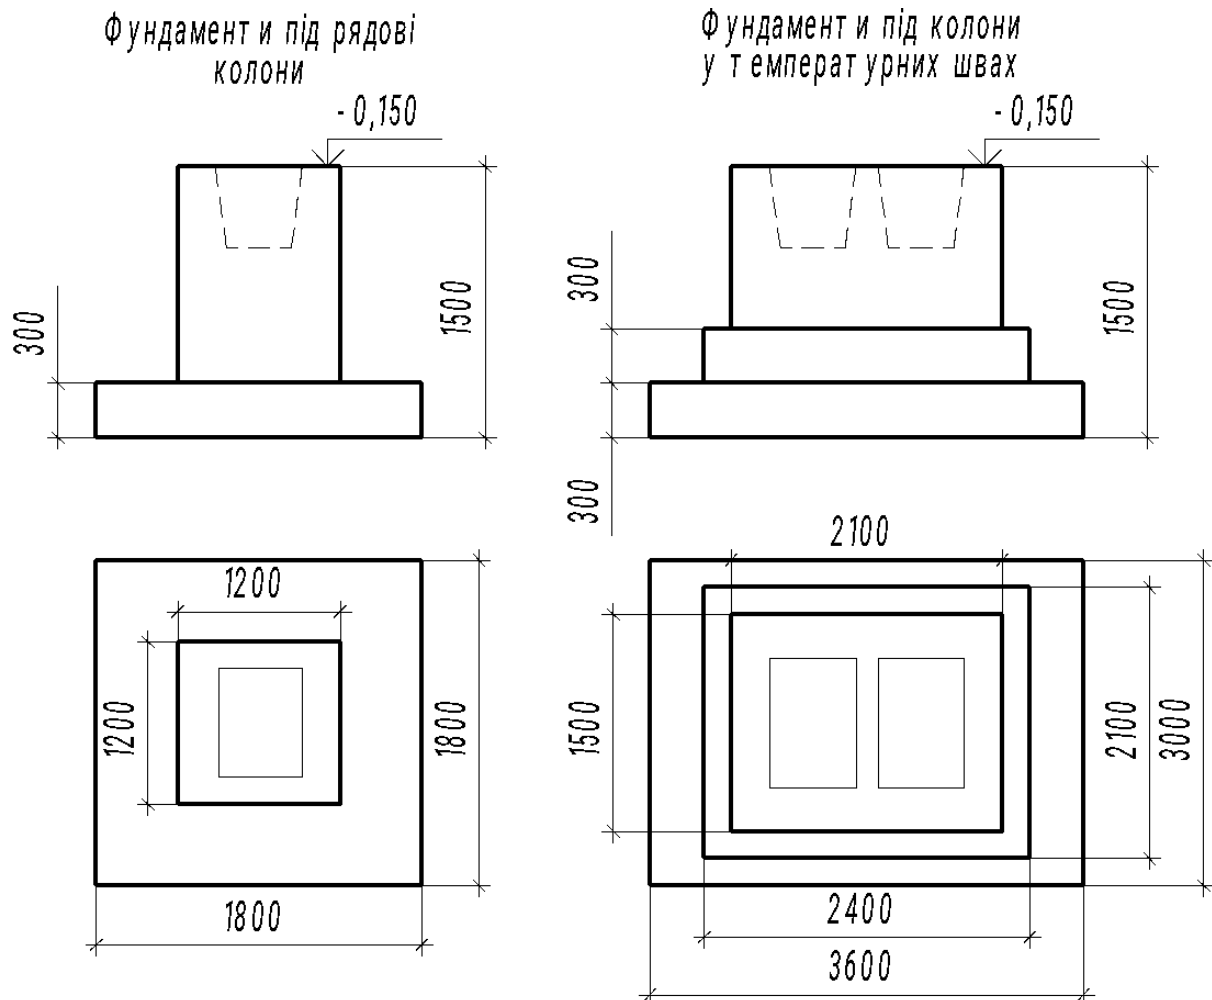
Монолітні залізобетонні фундаменти під типові колони прямокутного перерізу одноповерхових промислових будівель.
